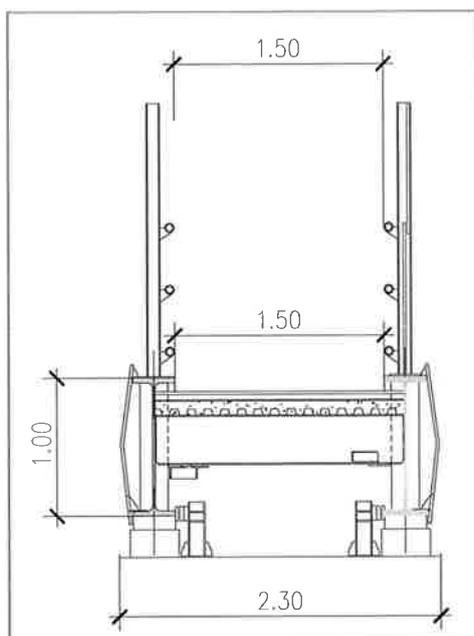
Sezione trasversale marciapiede ai lati del cavalcavia stradale esistente
